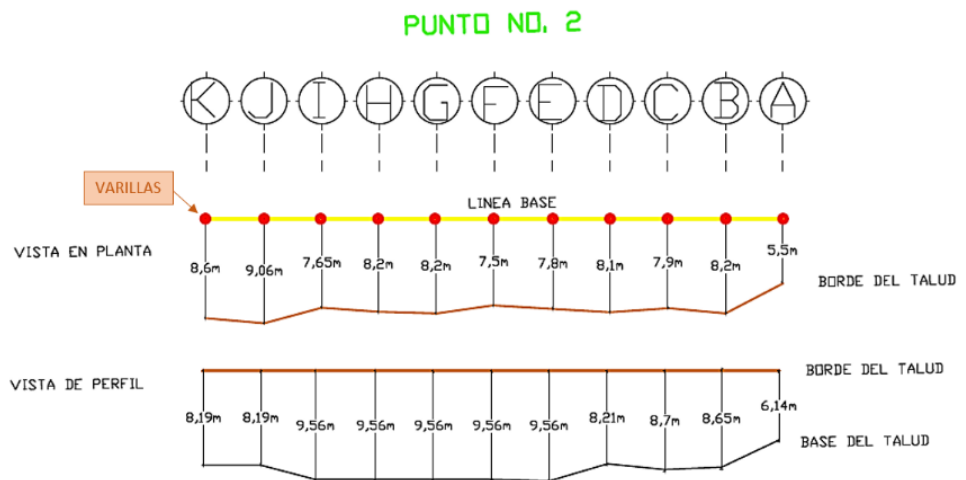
Dimensiones en planta y en altura finales del PUNTO No. 2 TALUD AEROPUERTO I
